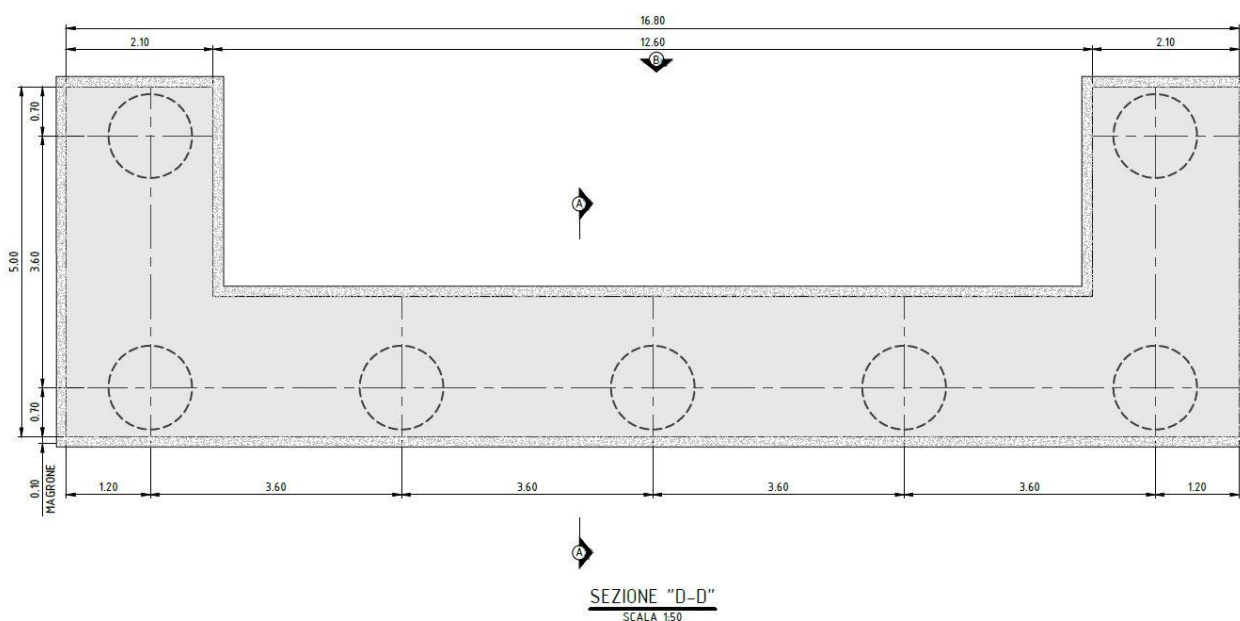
Vista in pianta della spalla (pali di fondazione)
